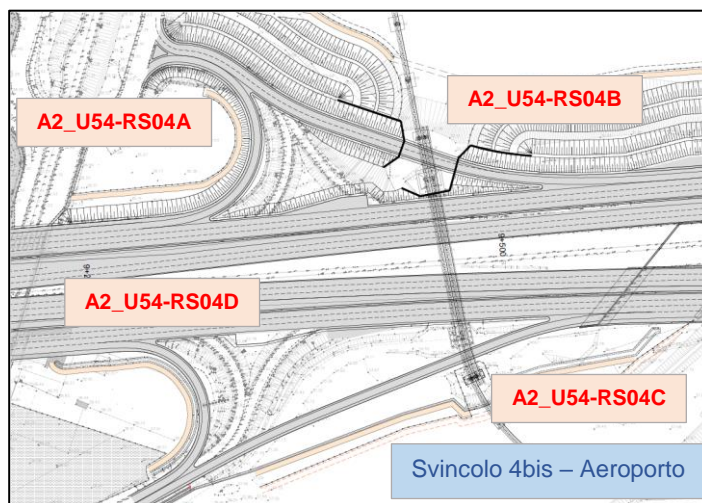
Stralcio planimetrico svincolo n.4 e 4bis
